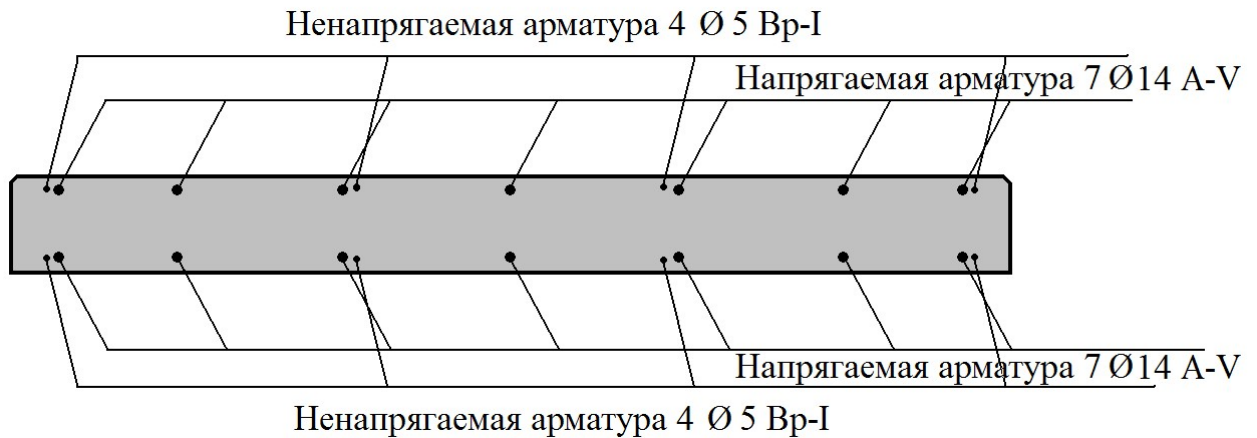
Схема расположения арматуры в плите ПАГ-20 (поперечный разрез) [1]
